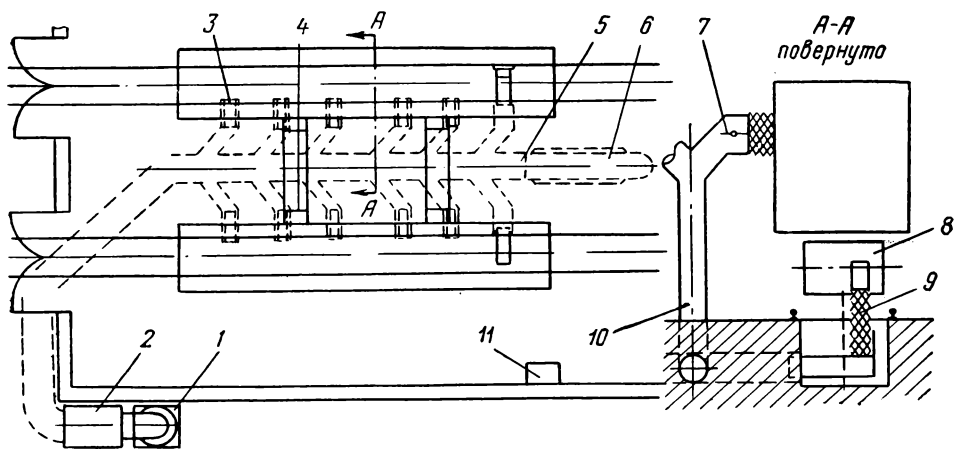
Схема вентиляционной установки на стойлах обдувки электровозов:
